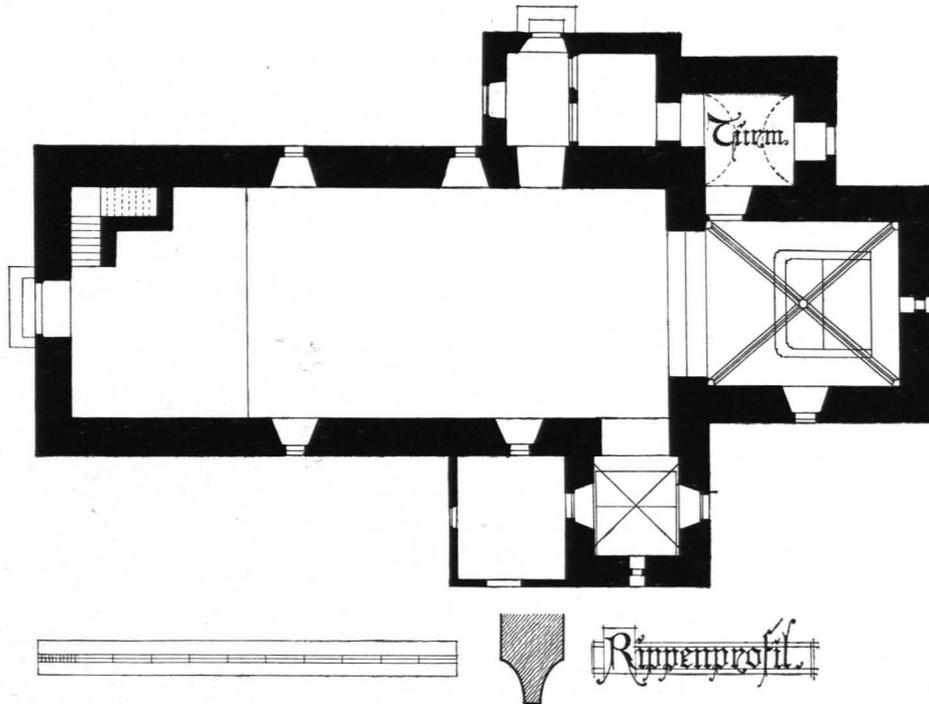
Messern, Pfarrkirche, Grundriß 1:200 (S. 411)
